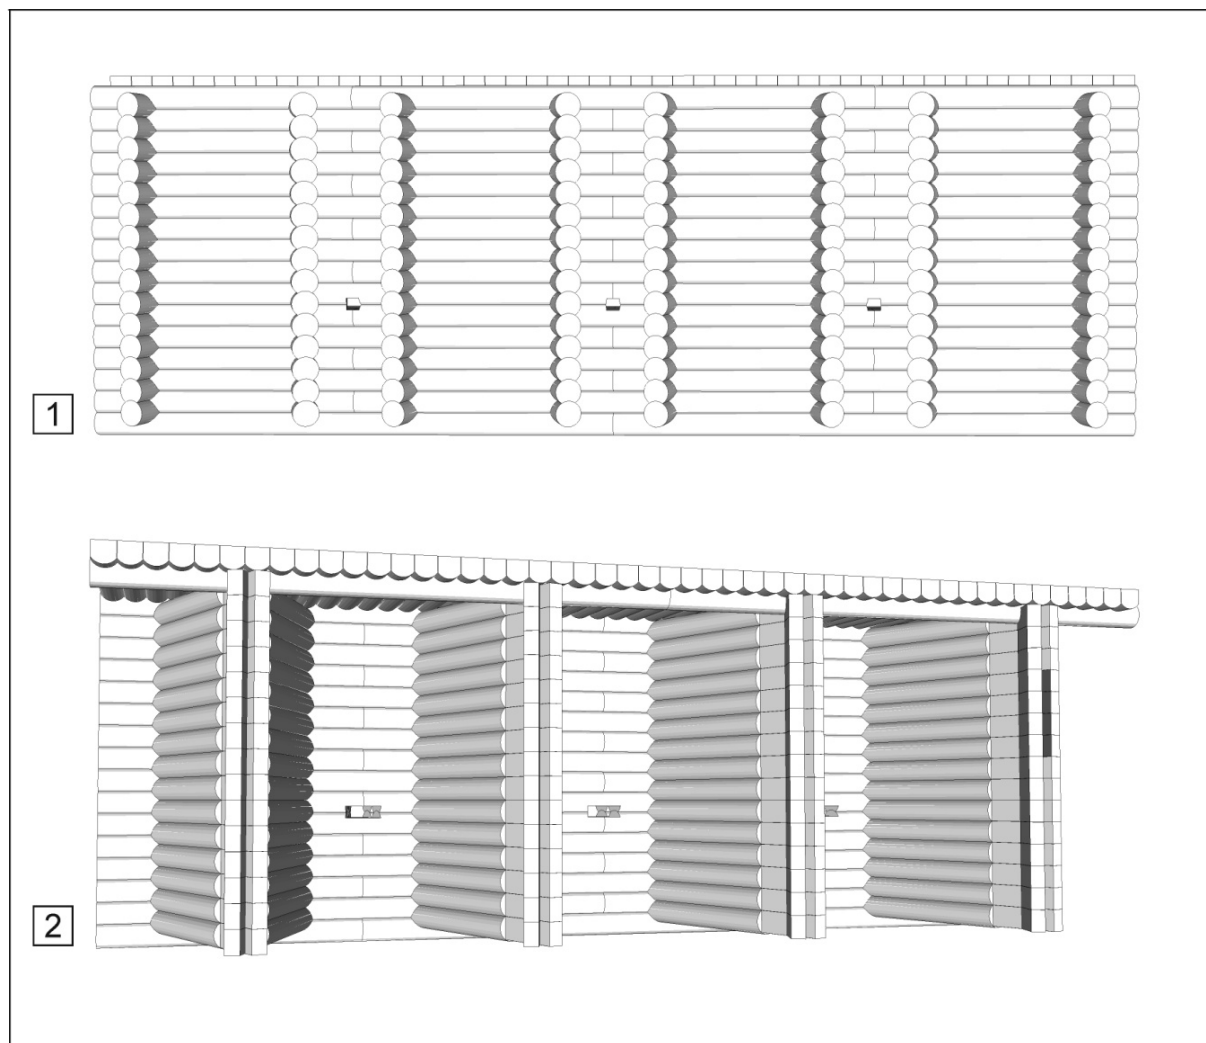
Реконструкция стены Сумского острога на «узких» тарасных срубах по описанию 1740 г.
